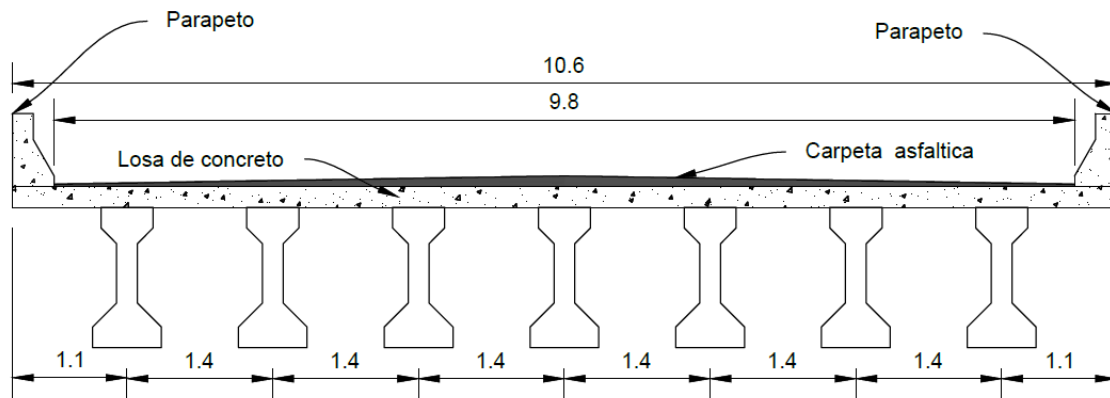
Sección transversal de la Superestructura de los puentes.
